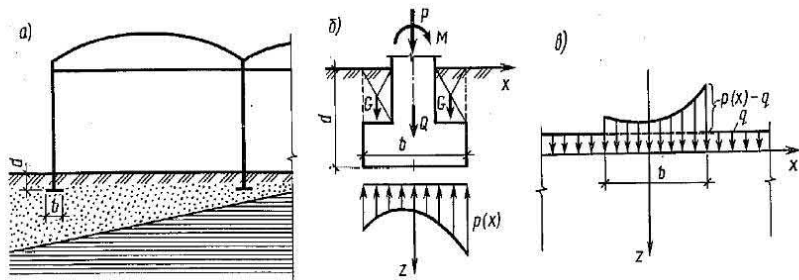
Схема взаимодействия сооружения и основания (а); схема фундамента и реактивного напряжения по его подошве (б); расчетная схема передачи нагрузок ниже подошвы фундамента (в)
